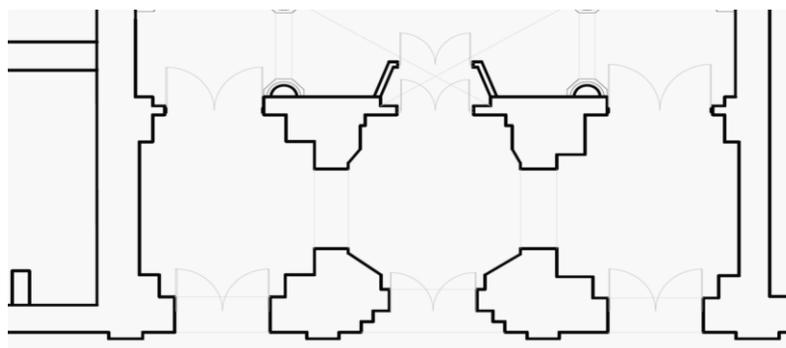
Planta de arquitectura levantamiento situación actual. Se observa una geometría distinta a la levantada por Joannon. Fuente: Autores.
